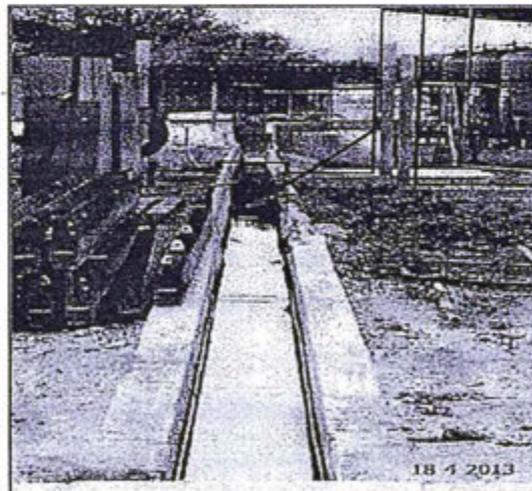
Salida de efluente de PTAR de planta Motupe para riego de áreas verdes.
